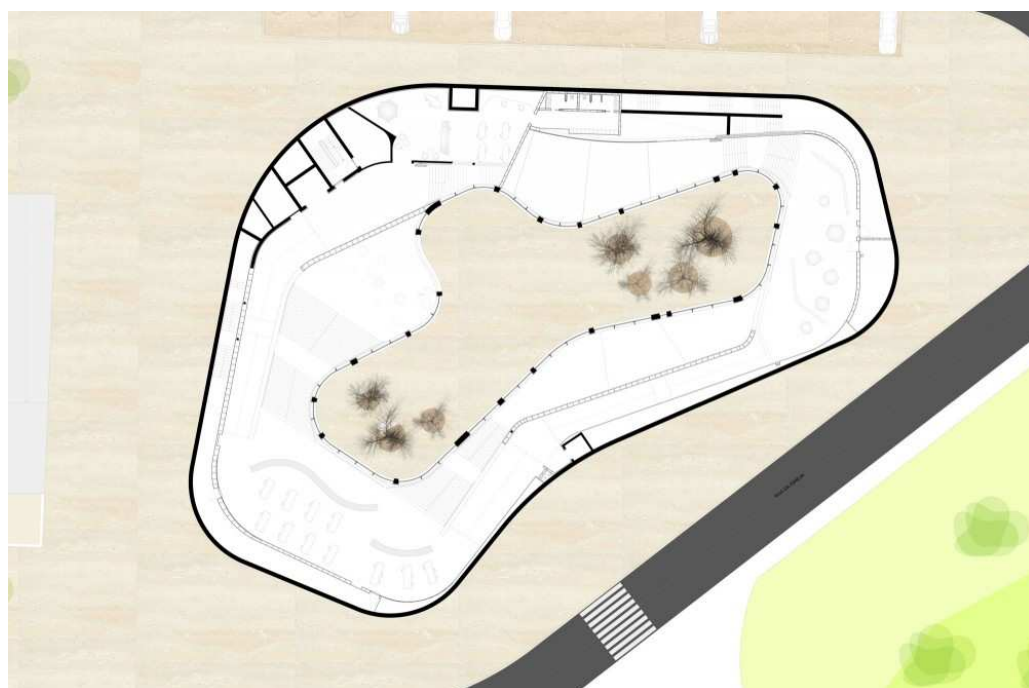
Planta Baixa | 2º Pavimento (FONTE: ARCHDAILY, 2011).
